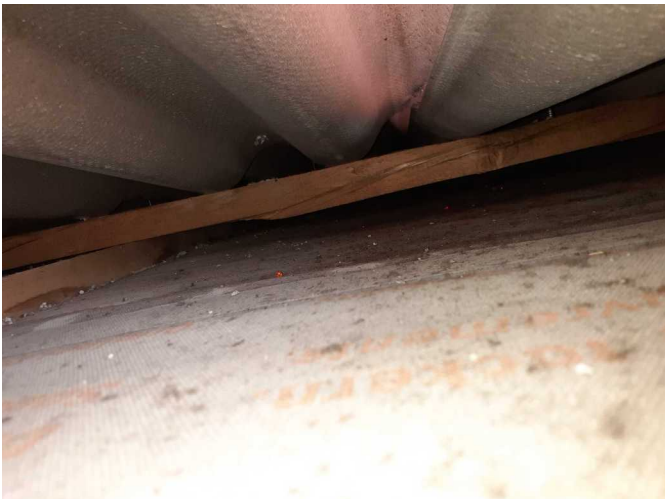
/ Povrch pojistné hydroizolace v místě sondy
